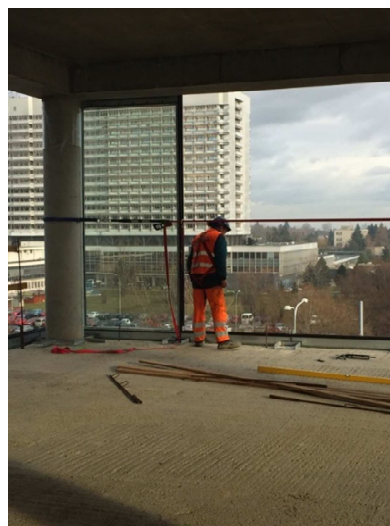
Detail uchycení kotvy LOP k monolitické konstrukci
